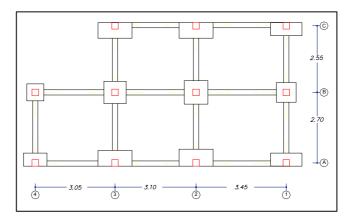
DISPOSICIÓN DE LAS VIGAS DE CIMENTACIÓN
